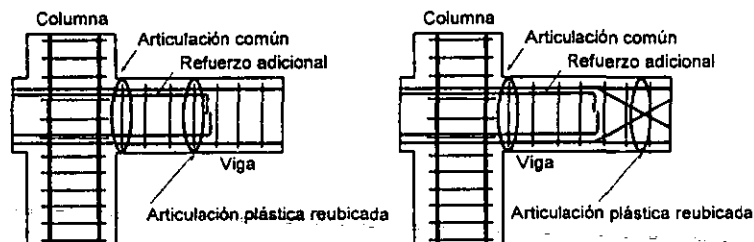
Detalle de conexión viga-columna para formar la articulación plástica lejos de la cara de la columna propuesta por Paulay y Priestley
